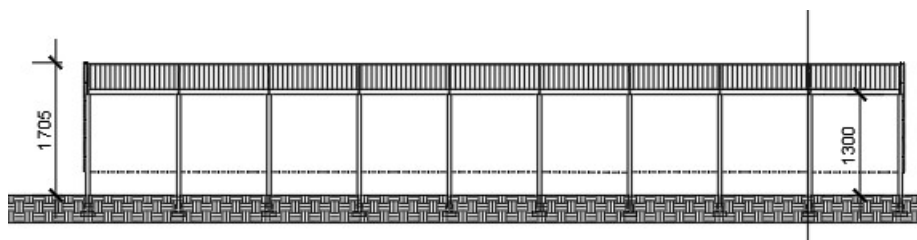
Anteprojeto: Corte Longitudinal do Barracão (fonte: Arq. Marcos Faccin da Silva)
